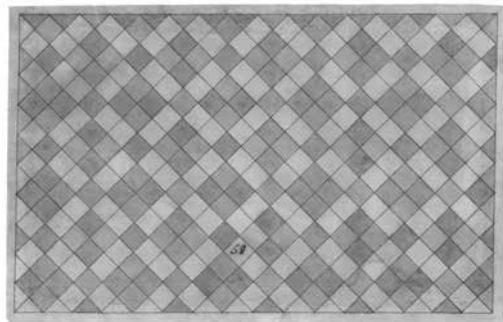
Dibujo en papel del Proyecto de pavimentación (propuesta), s. XVIII, ¿Juan de la Torre y después de López?. ACS_ planos-7-1.
